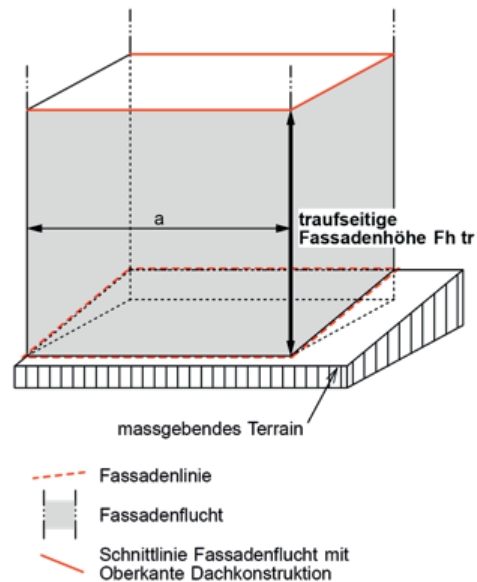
$F_h tr$ bei Gebäuden mit Flachdach, dessen oberstes Geschoss als Vollgeschoss gilt.
